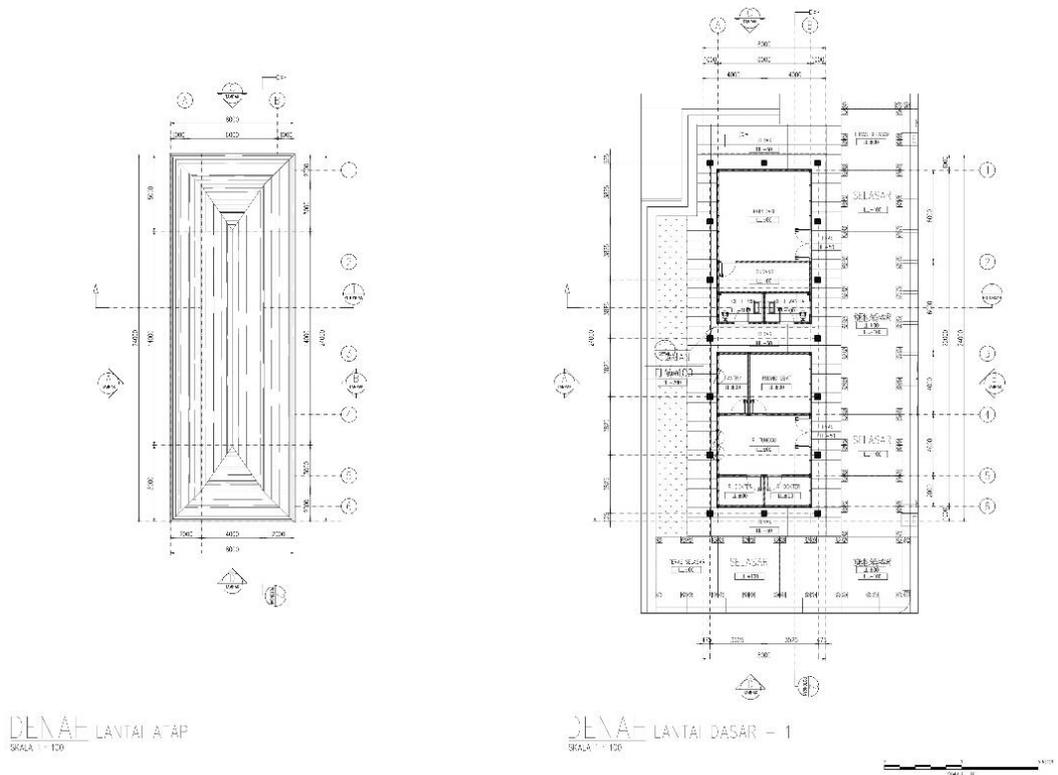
Denah Atap Bangunan Administrasi – lantai atap
